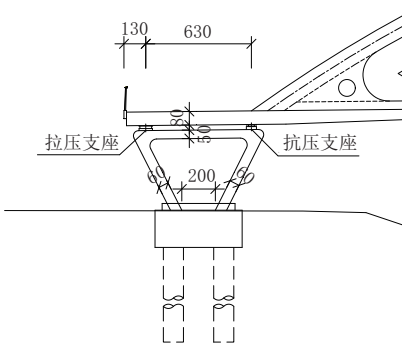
倒三角墩4支点连续梁体系立面图(单位:cm)
